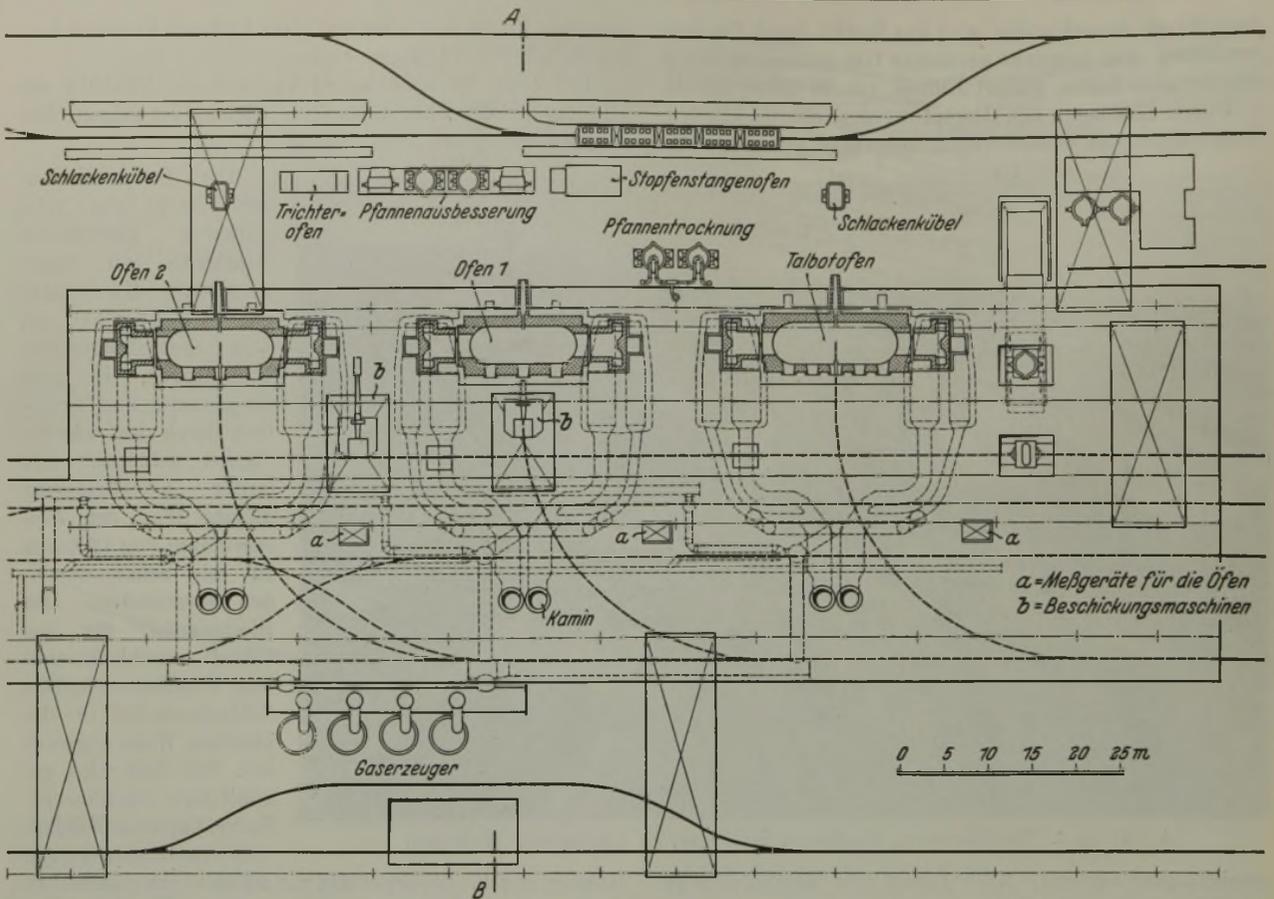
Siemens-Martin-Stahlwerk, Grundriß.
